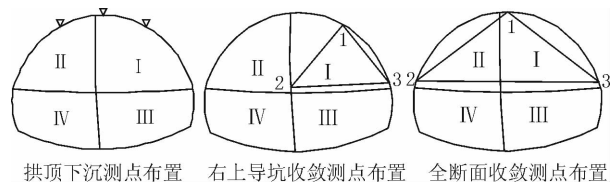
浅埋偏压段 CRD 施工工序及测点布置示意图
